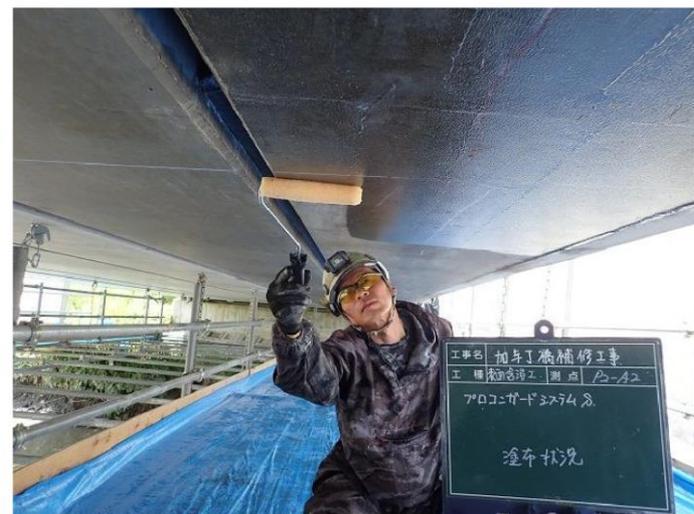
シラン・シロキサン系表面含浸材塗布工の施工状況
